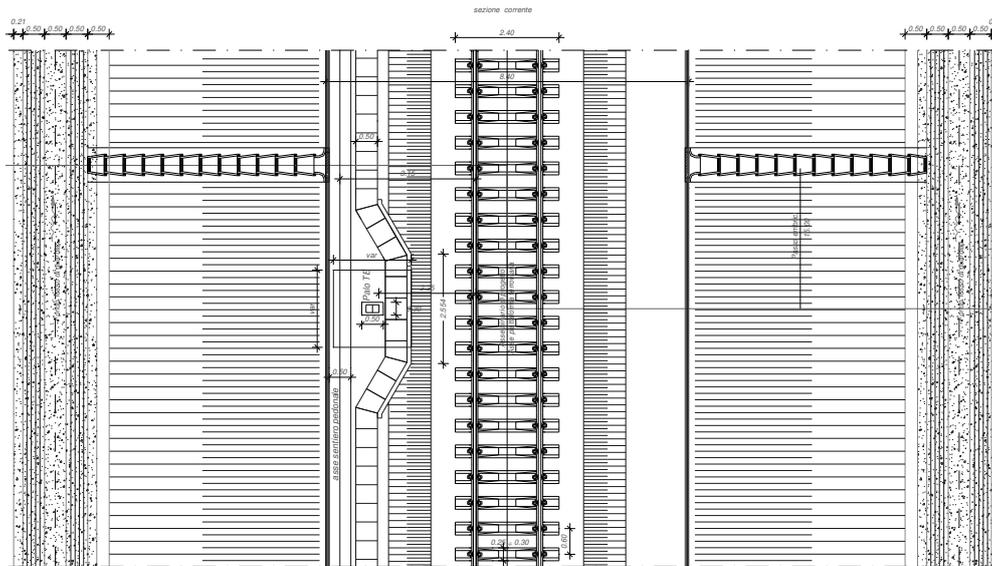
Stralcio planimetrico per sezione tipo ferroviaria in rilevato a singolo binario (piattaforma in retto) con $H_{rii} \leq 6,00$ m
